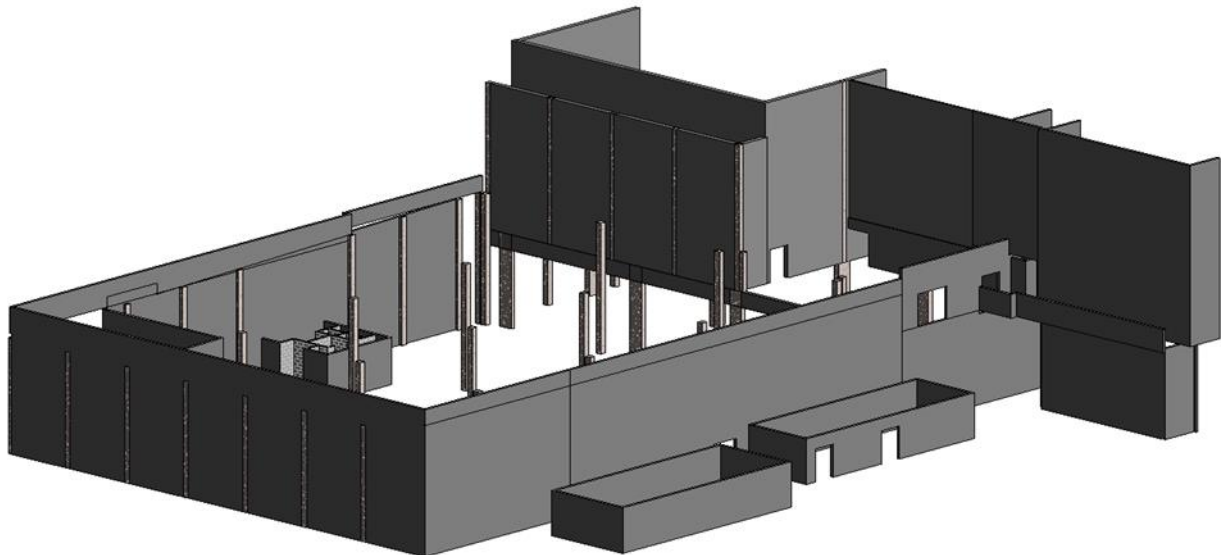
Modelo BIM com introdução de objetos referentes às paredes
